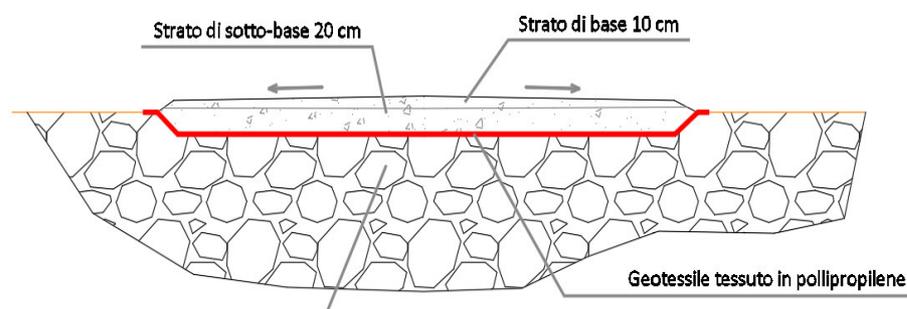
Sezione trasversale tipo della viabilità interna al sito.
